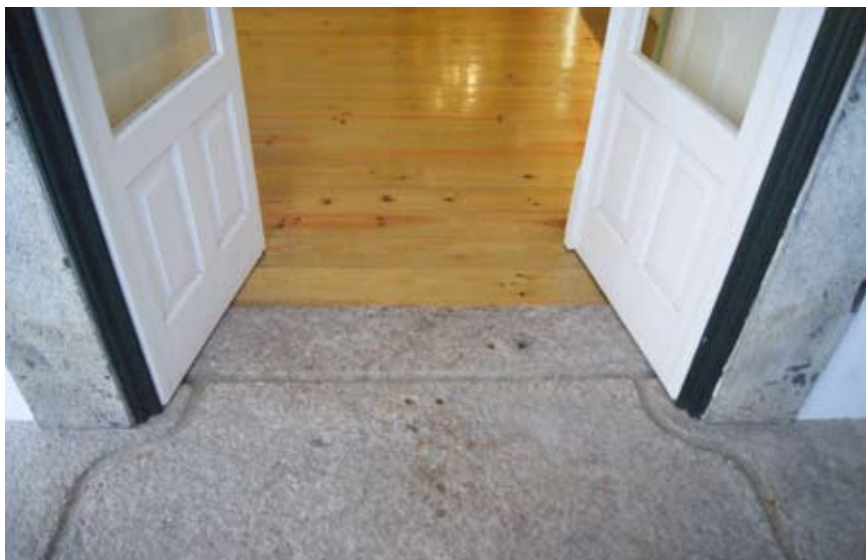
Particolare dello stacco tra pavimento interno e esterno.
